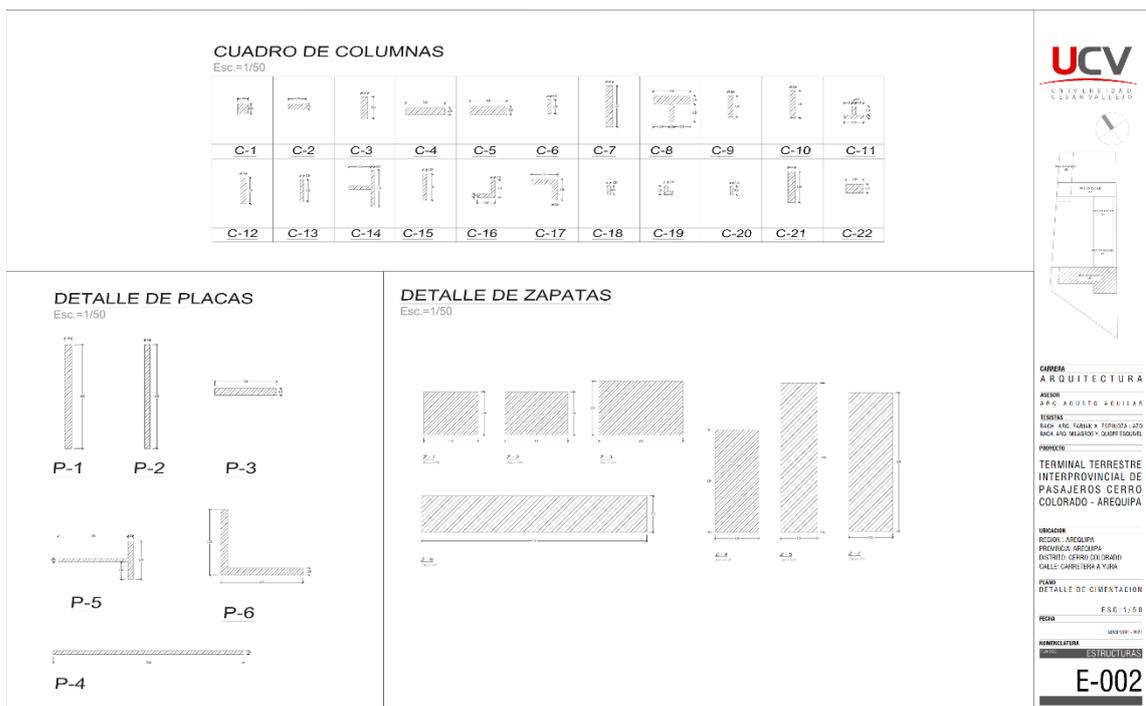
Plano de Detalles de Columnas, Placas y Zapatas.
